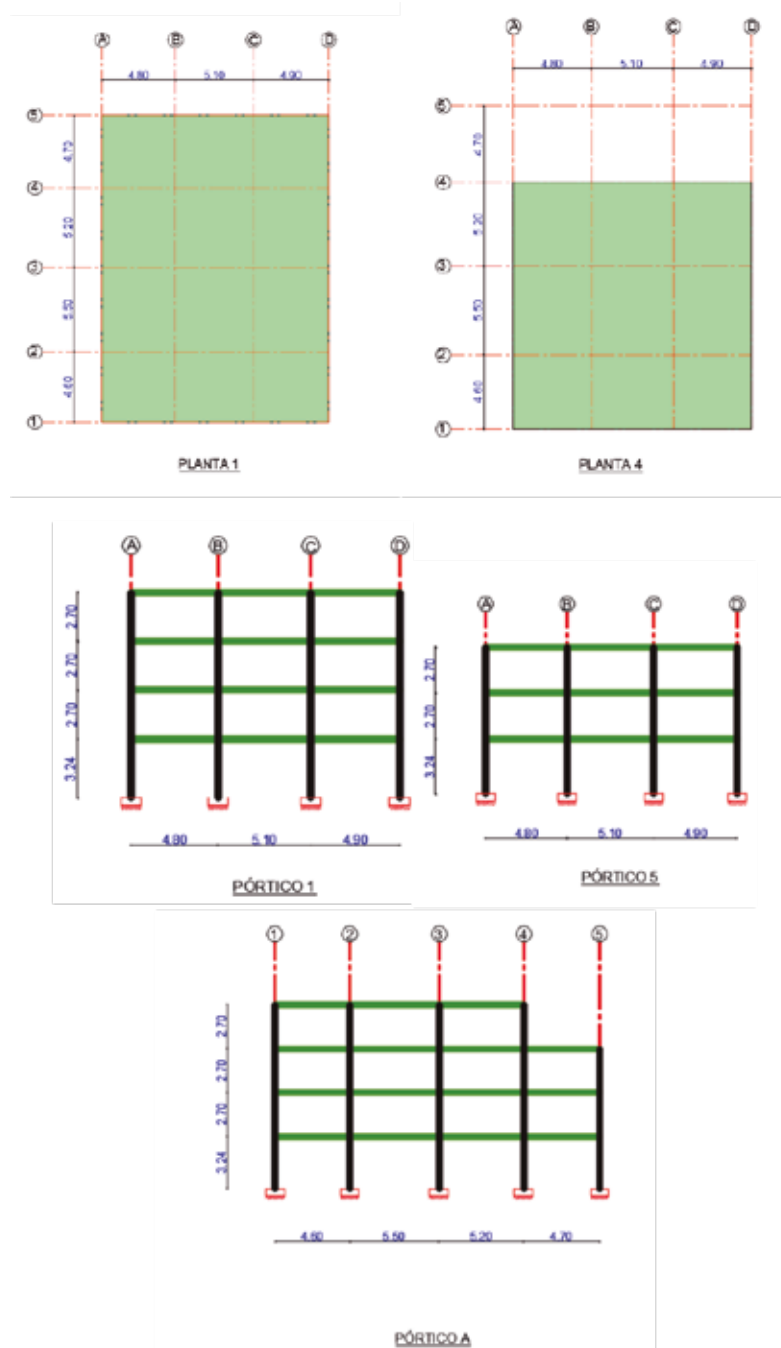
Vista en planta y en elevación de la estructura. Elaboración: Sarango, Jéssica, 2018.
